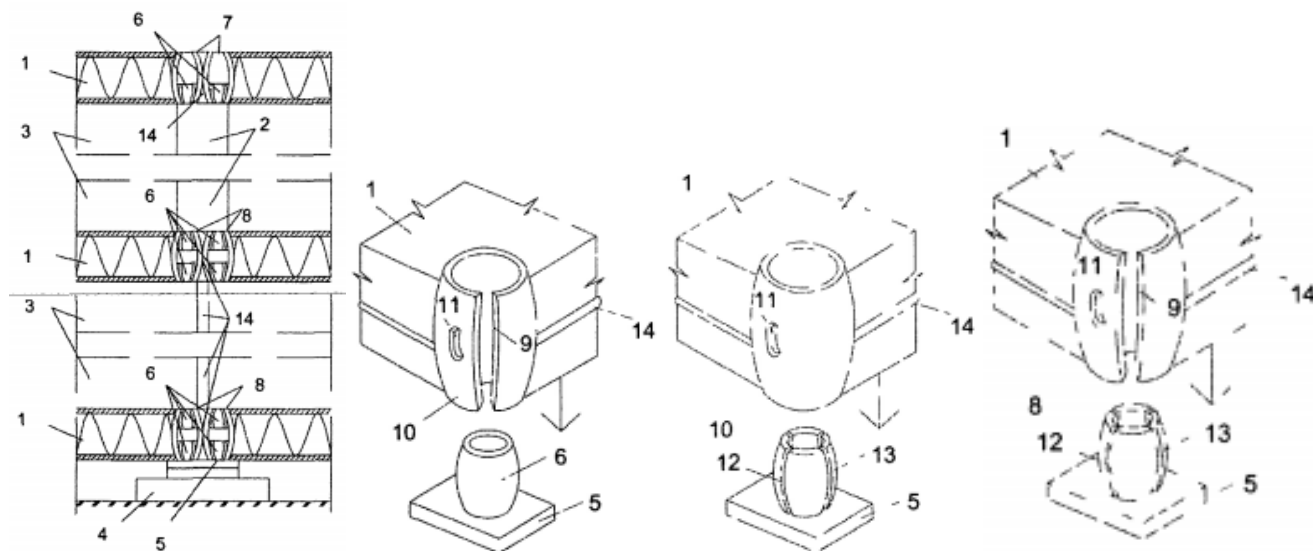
Технологія монтажу 2-х поверхового індивідуального житлового будинку з сендвіч-панелей з використанням безболтового вузла: 1 – горизонтальні несучі елементи; 2 – вертикальні несучі стійки; 3 – панелі; 4 – елементи фундаментів; 5 – пластини; 6 – шип клеєний; 7, 8 – муфти кріплення панелей перекриття і підлоги; 9, 12 – вертикальний проріз на всю висоту муфти; 10, 13 – бокові стінки муфти; 11 – отвори для фіксаторів; 14 – ущільнювач
